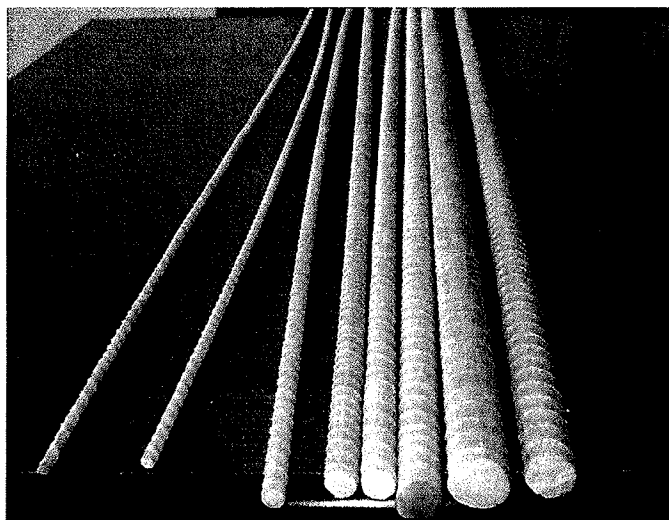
Bare din material compozit pentru armarea betonului Ø4 – Ø16 mm.
